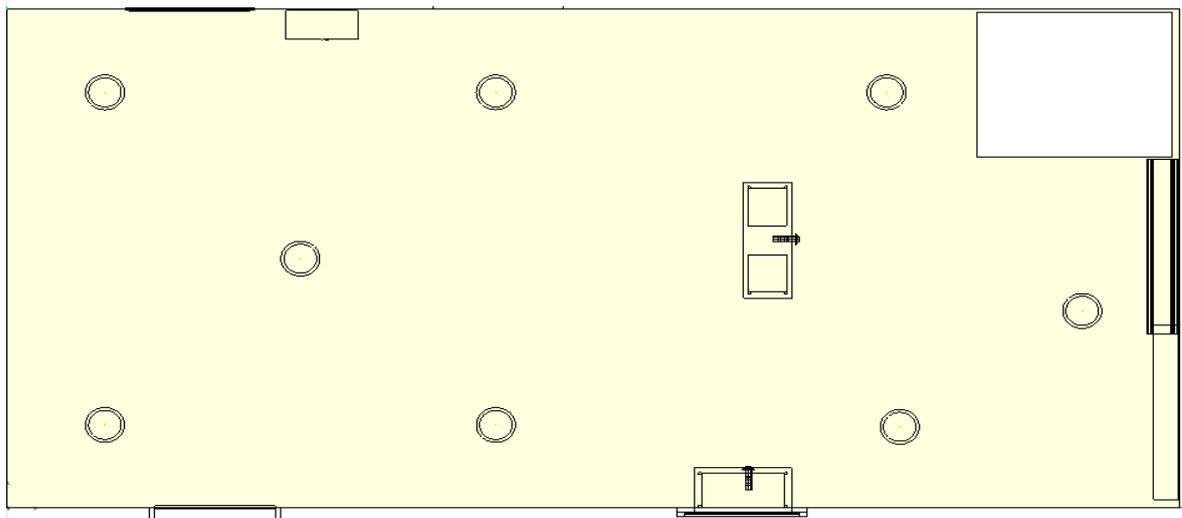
Plano del galpón de Herrería con la ubicación de las luminarias.
